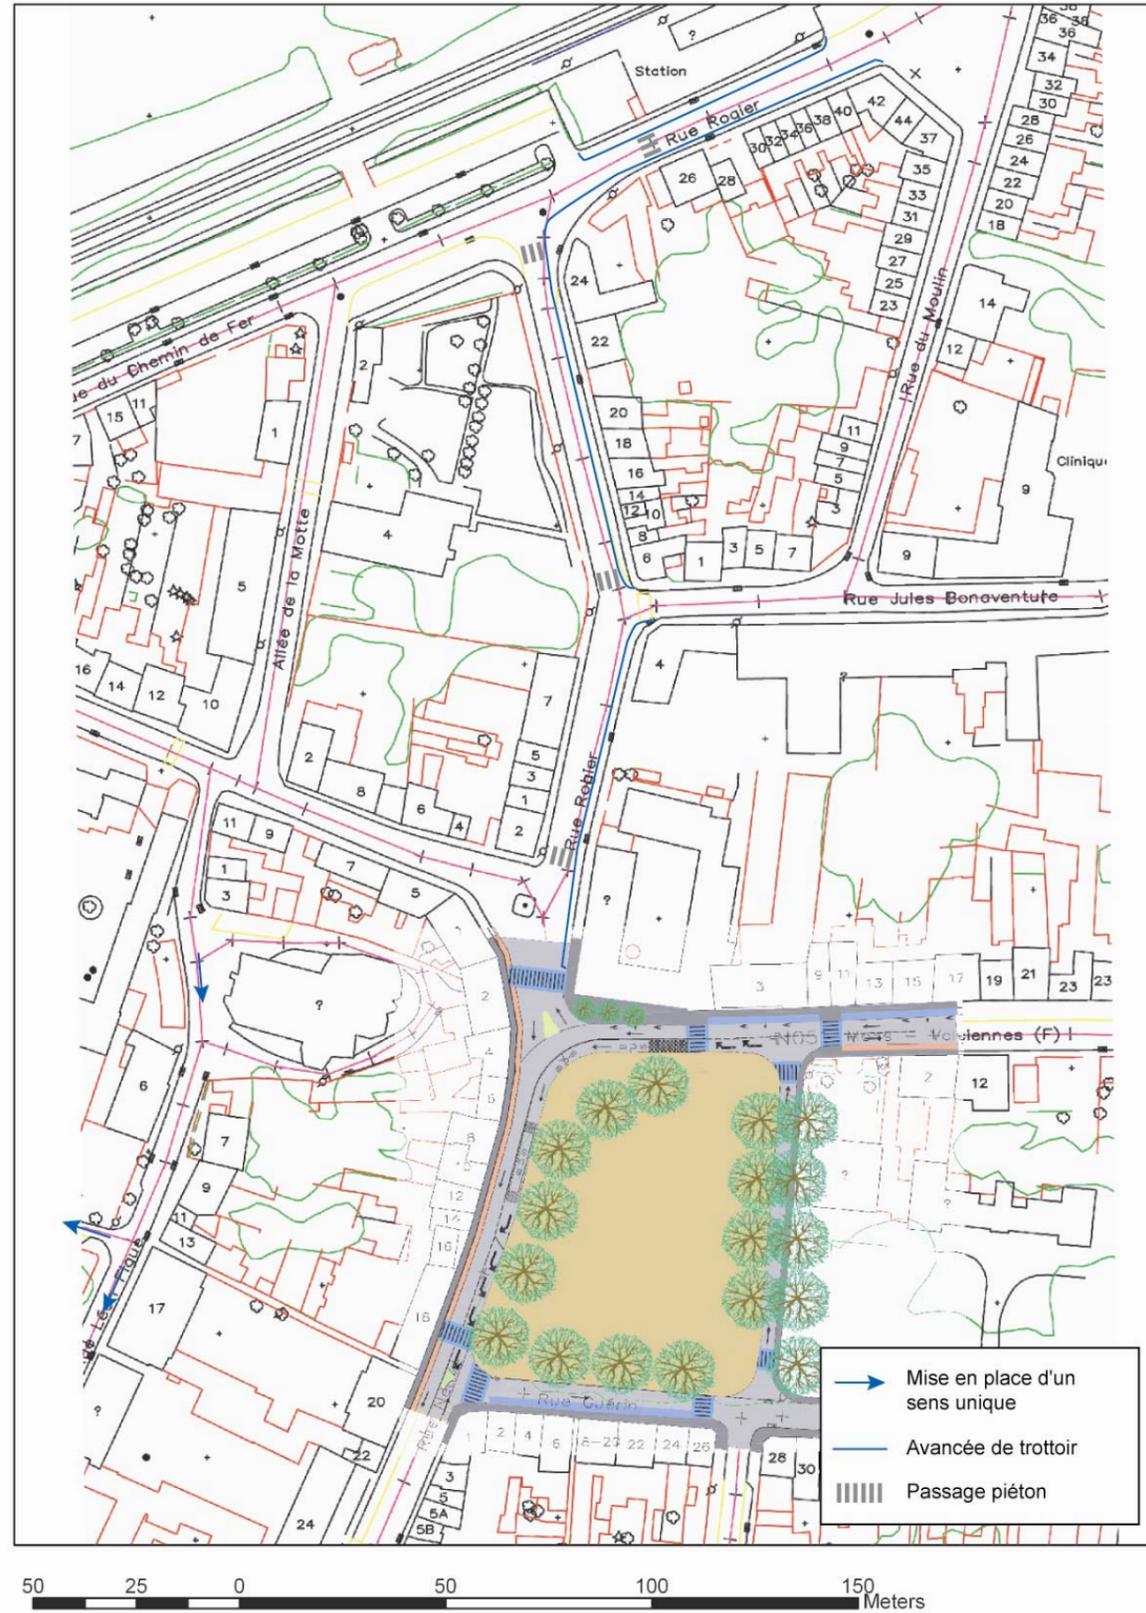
Aménagement cheminement piéton Boussu centre-gare Boussu
